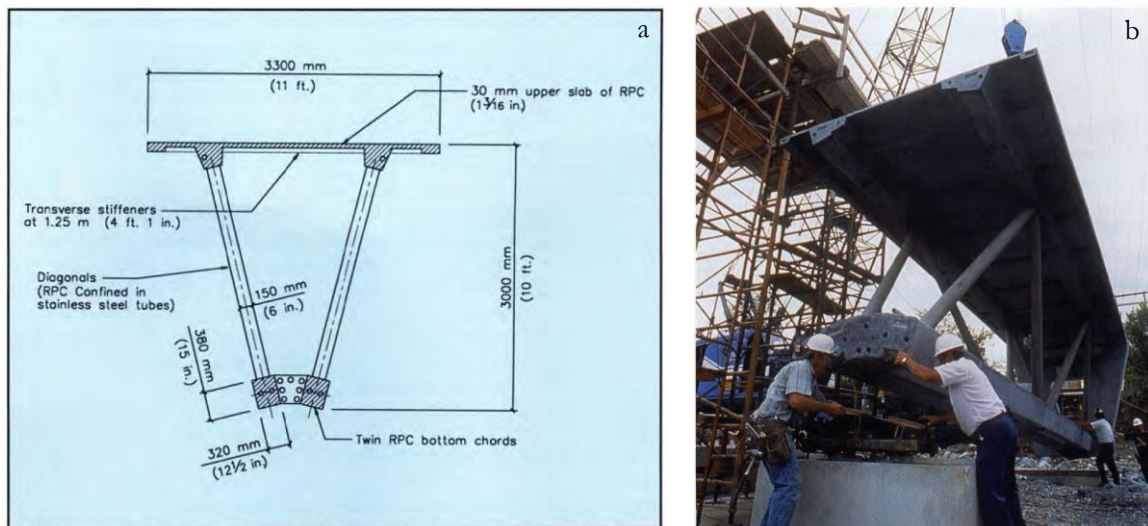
a) Detalhe de projeto da secção transversal da estrutura; b) Secção pré-fabricada a ser preparada para montagem (Blais & Couture, 1999).
